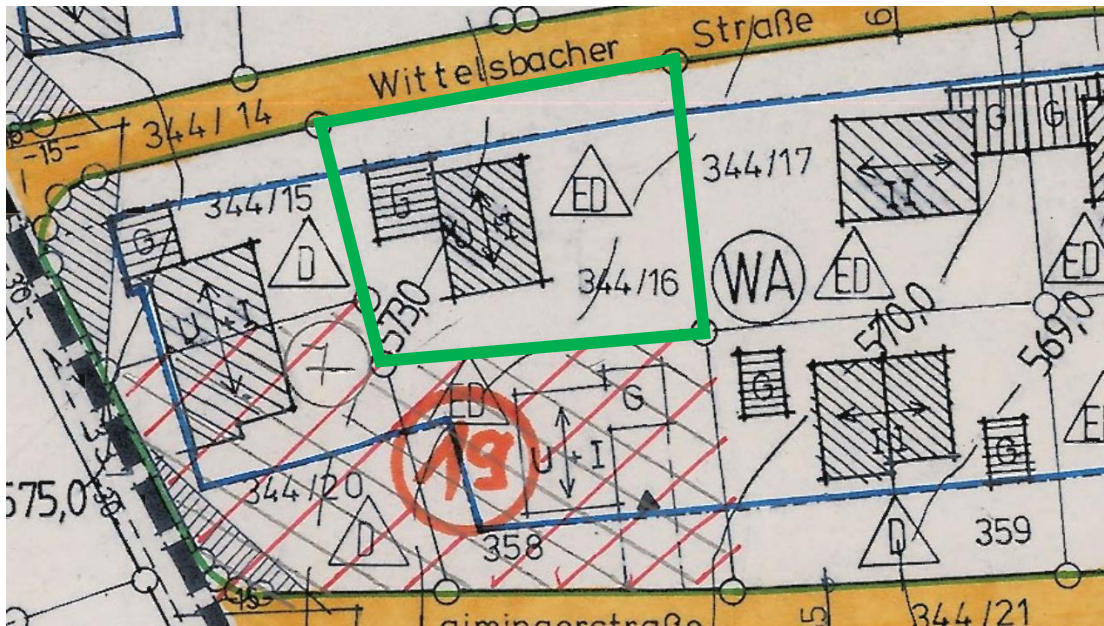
Bebauungsplan Obing Süd-Ost mit Änderungsbereich, Quelle: Gemeinde Obing
